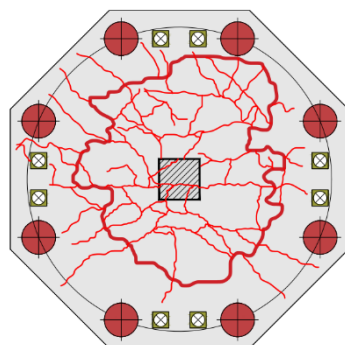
Mapa de fissuração das lajes.
